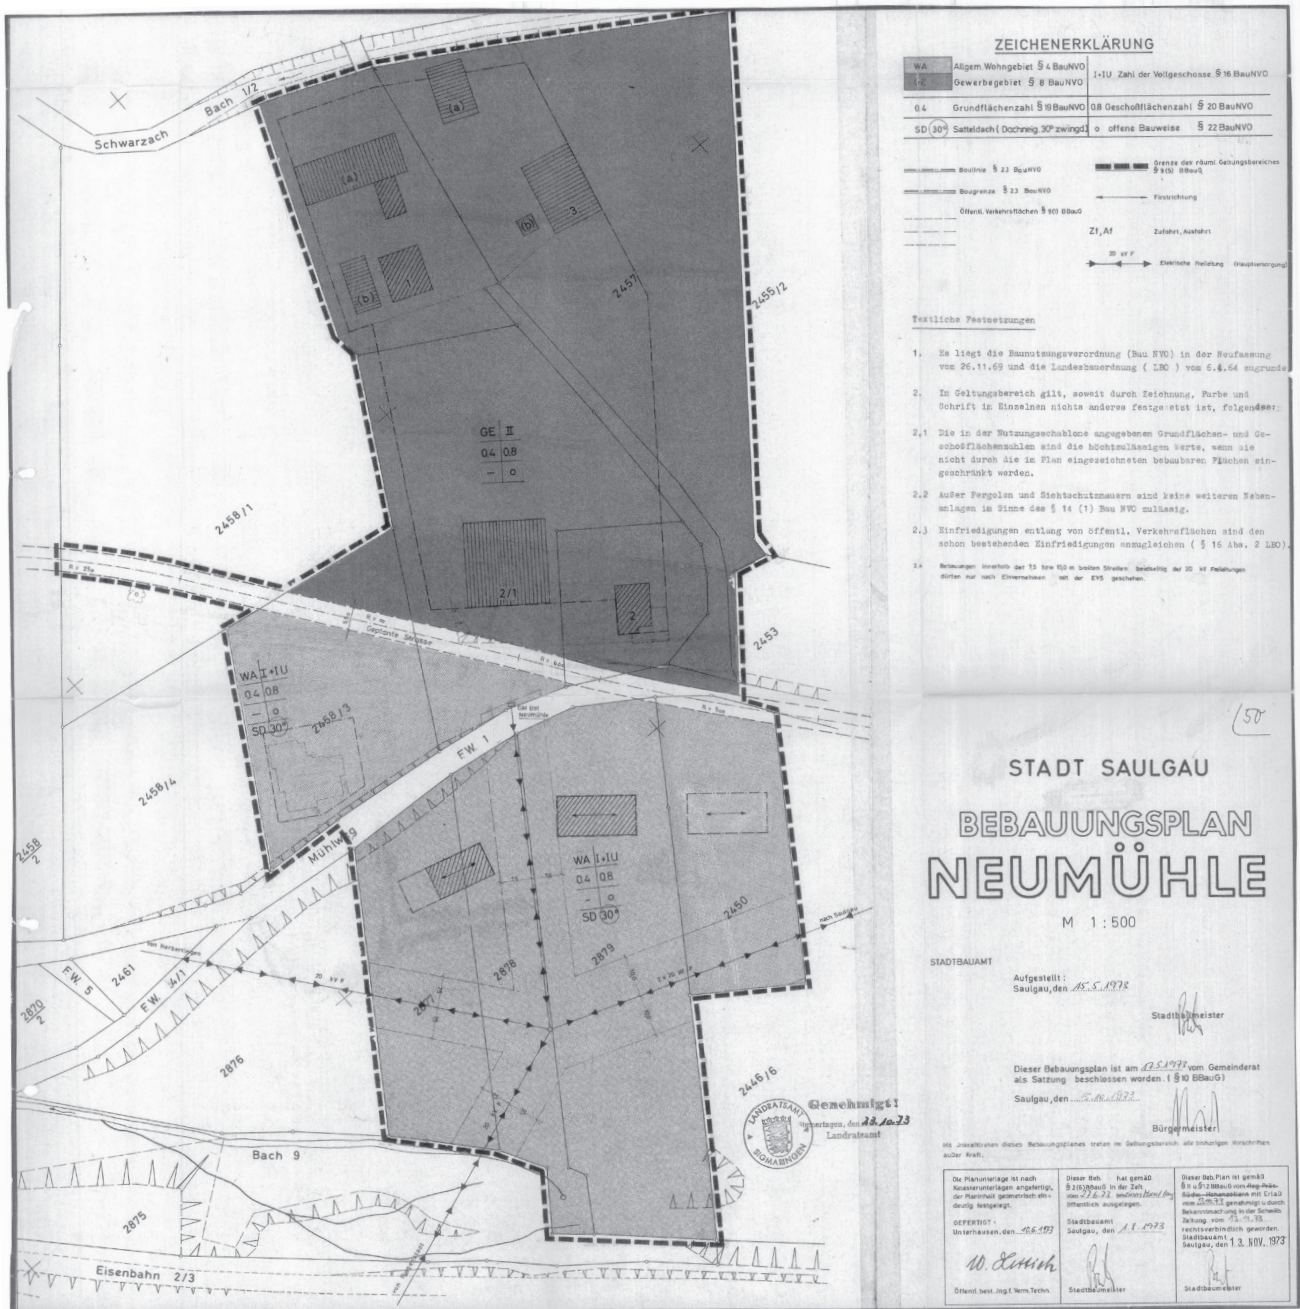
Bebauungsplan Neumühle (Stadt Bad Saulgau)
